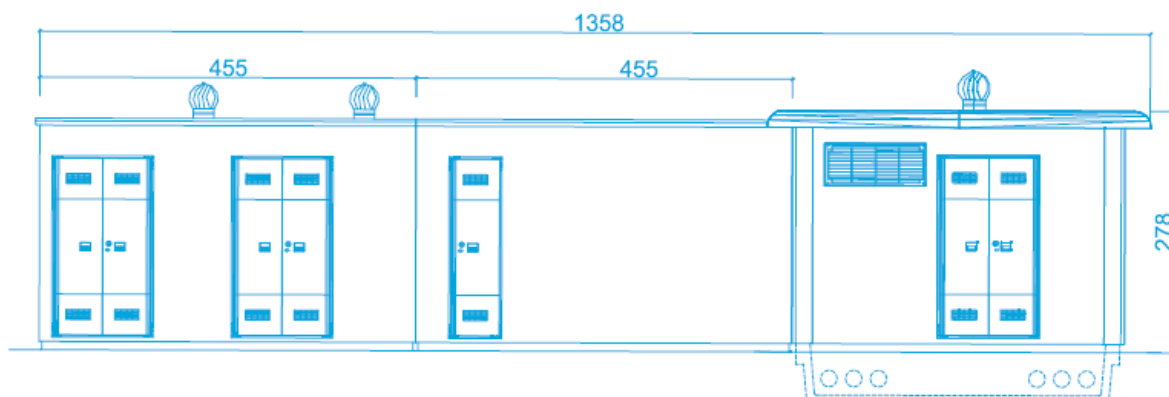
Prospetto longitudinale del fabbricato FAVR nel Progetto approvato
